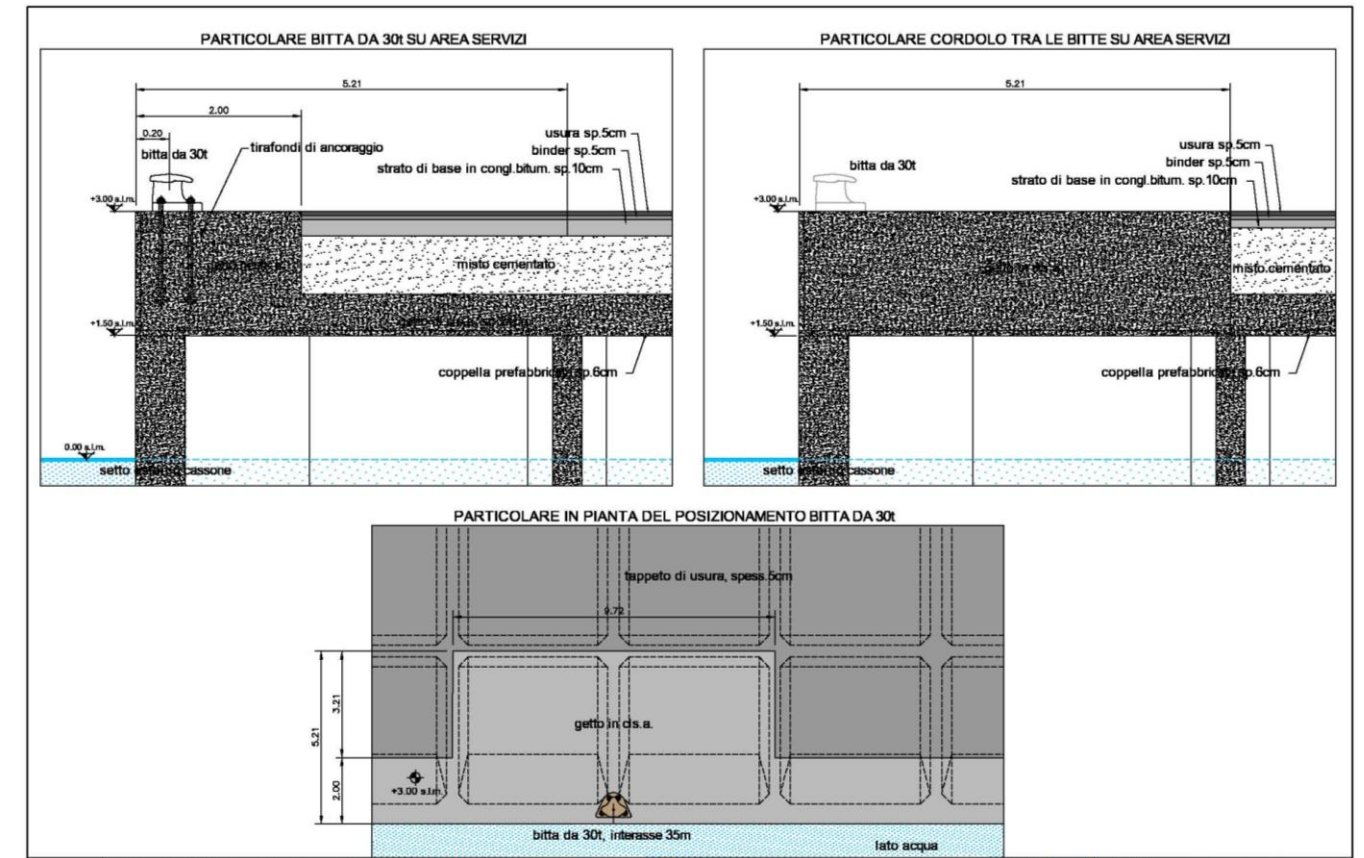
Banchina servizi - particolare della bitta di ormeggio da 30
